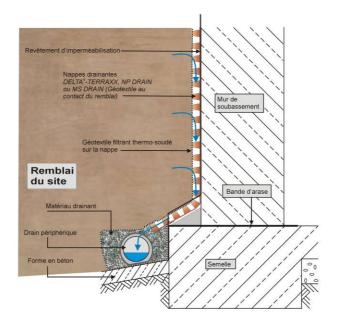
NEPE drainante – pied de construction sur imperméabilisation
